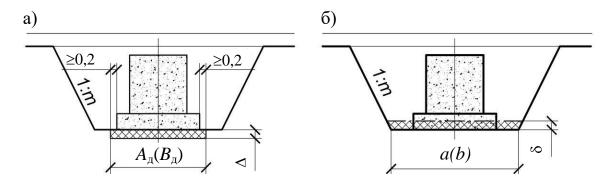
Схема доработки дна выемки: а) для глинистых грунтов; б) для песчаных грунтов
